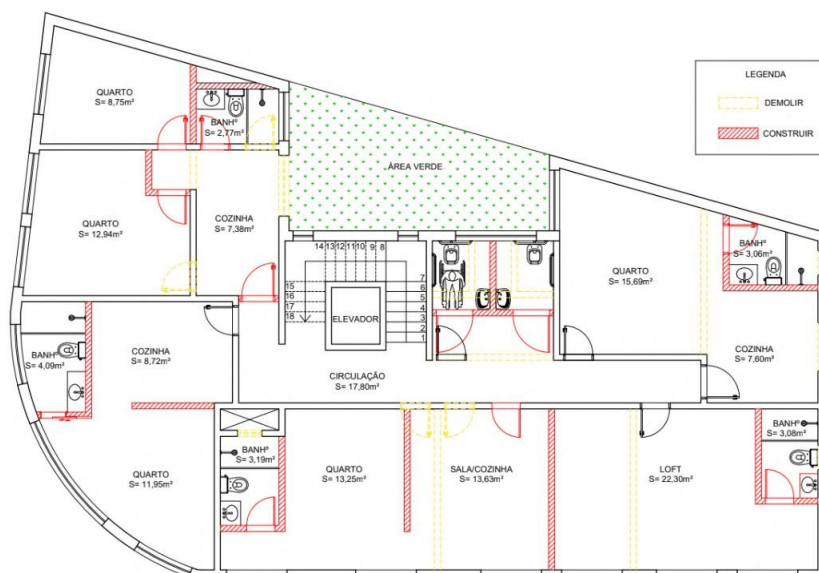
Demolir/Construir - 1º Pav., A Brasileira
